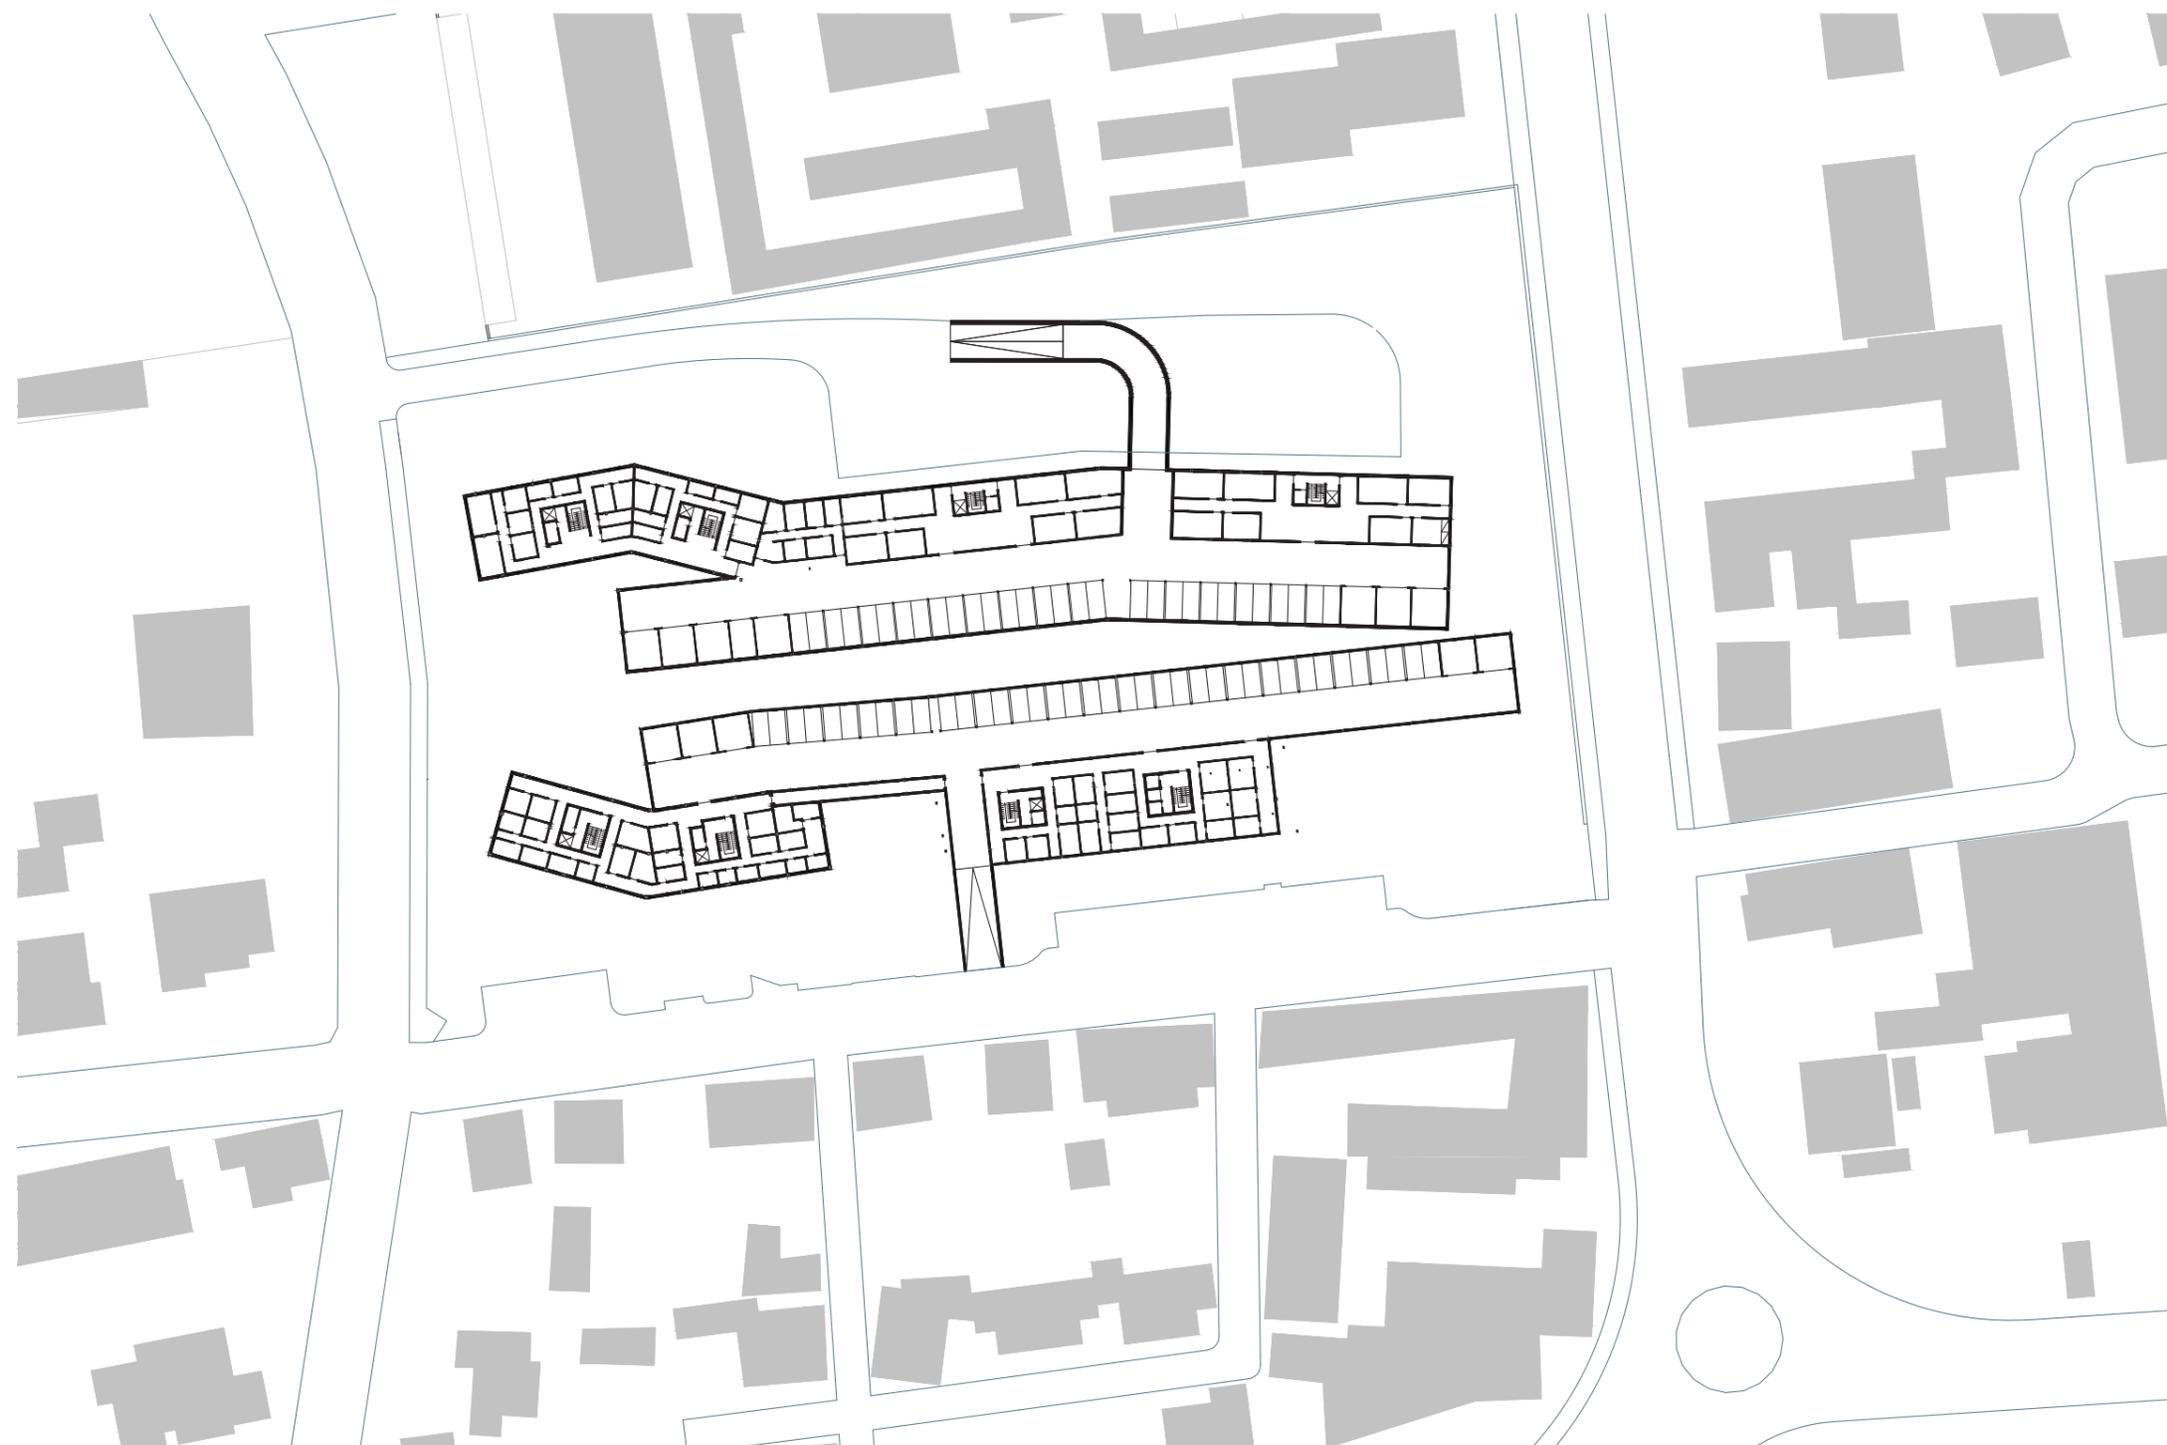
Planimetria che rappresenta garages e cantine del masterplan
